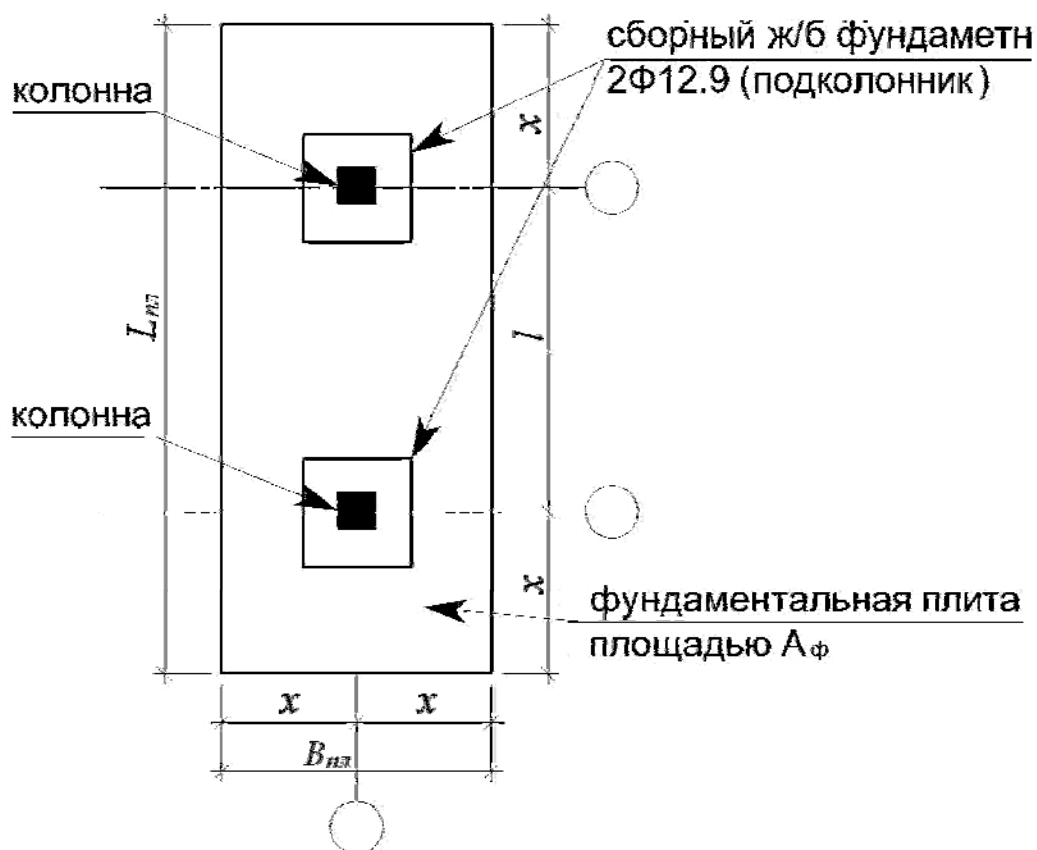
Схема к определению ширины и длины фундаментной плиты под две колонны.
